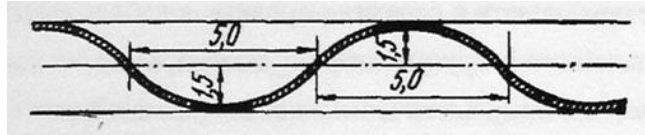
Схема укладки кабелю на схилах („змійкою”)
